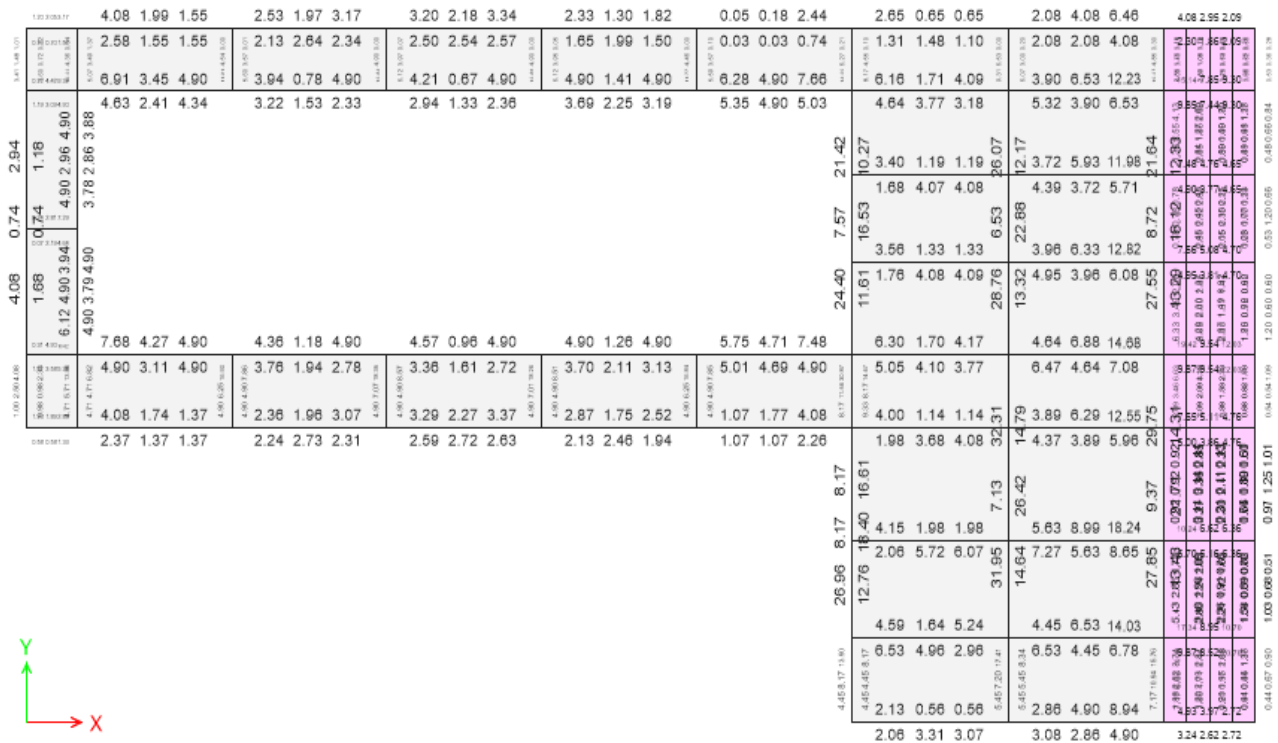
Refuerzo Longitudinal vigas en el modelo de restaurante. Piso 1 N+3.60. Cm2
